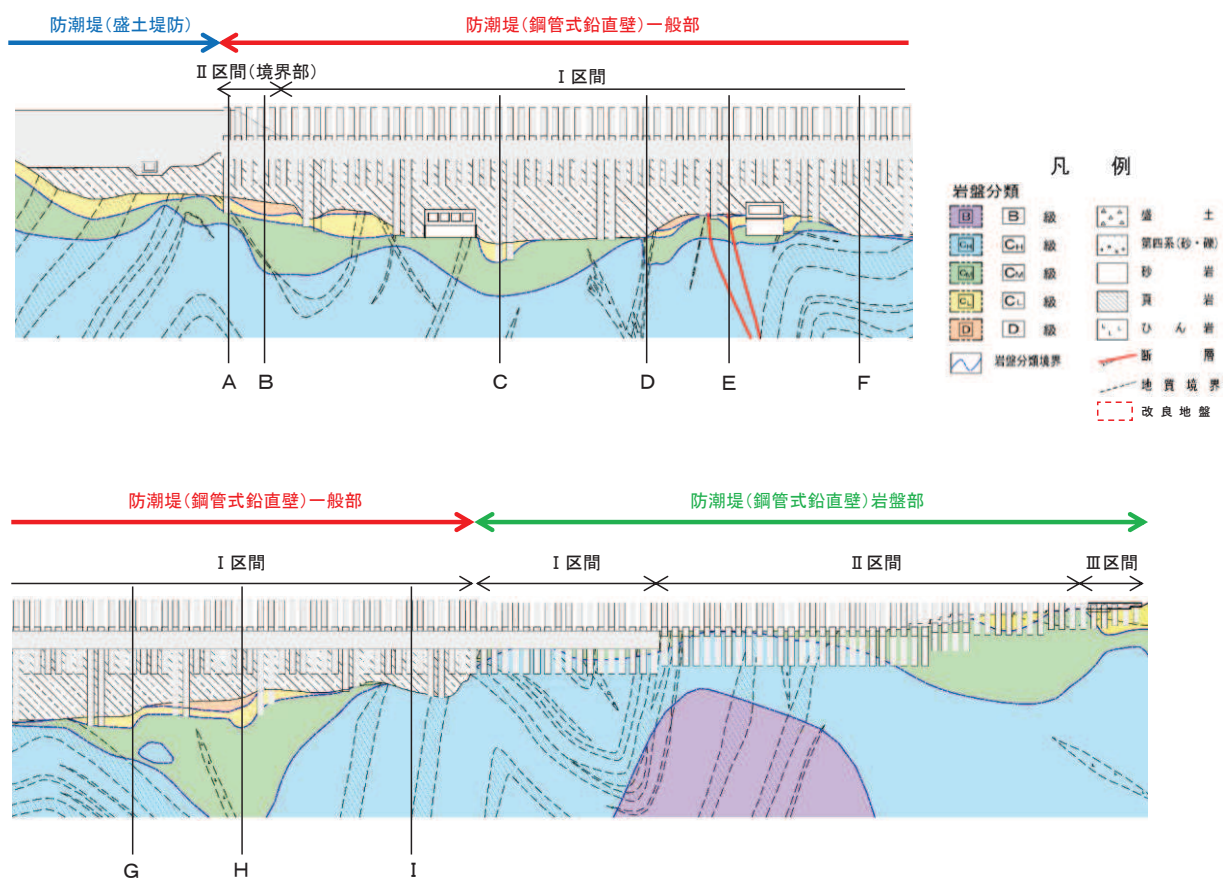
鋼管式鉛直壁（一般部）縦断面図
